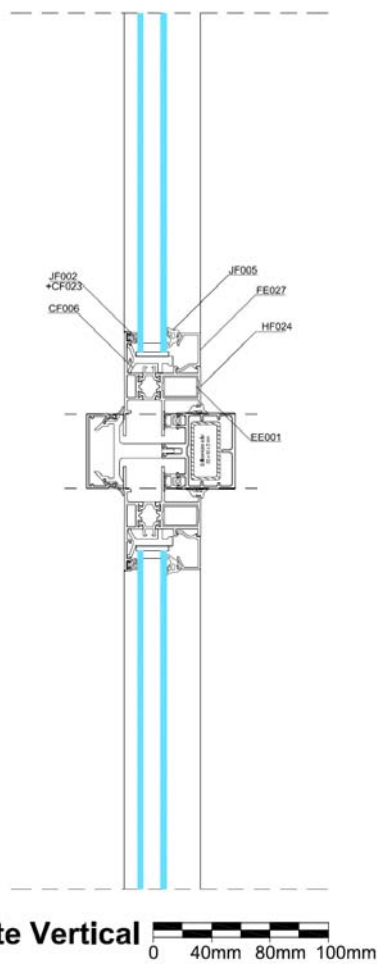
Corte vertical (b): Ligações entre os perfis da grelha estrutural e o módulo padrão fixo.
